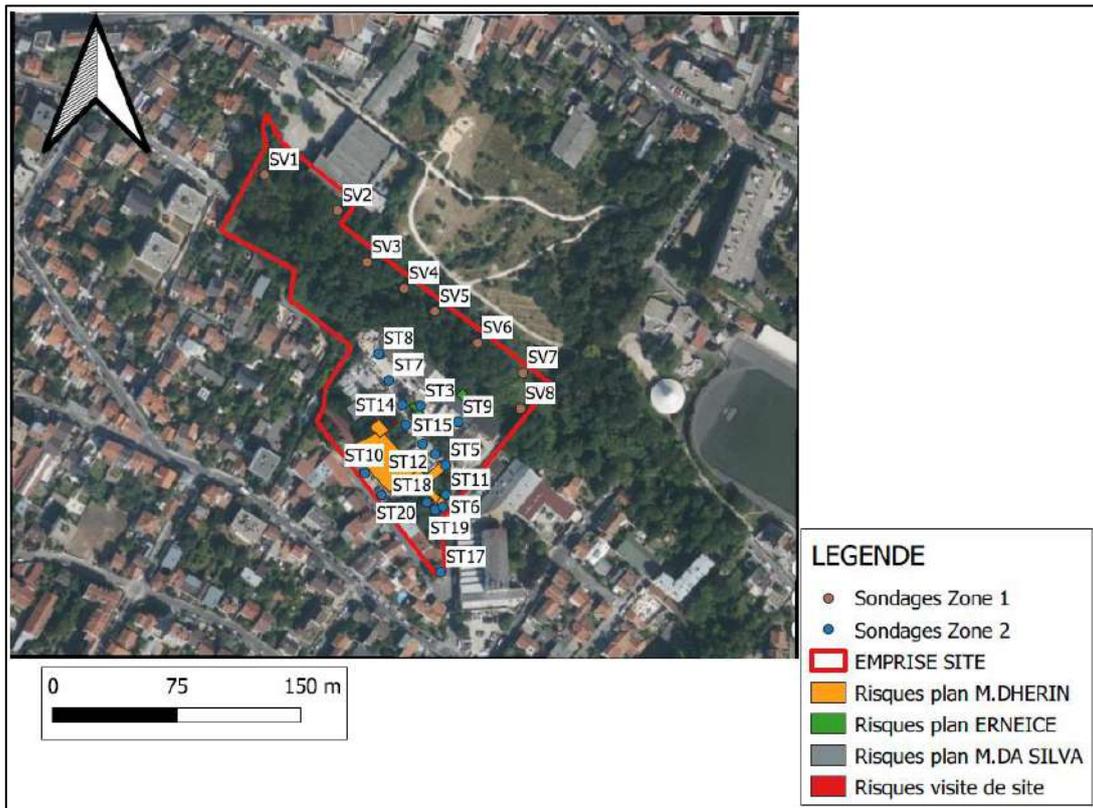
Plan des sondages sur une photographie aérienne-Hors garage (1/2)
